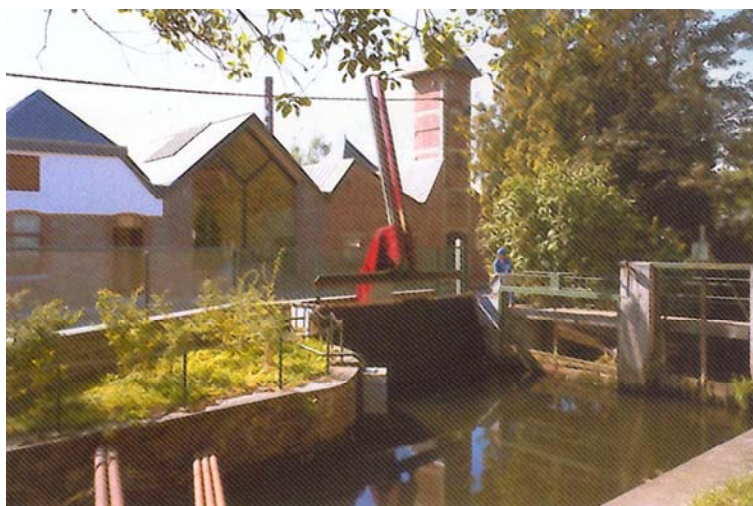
La zone possible d'aménagement d'un exutoire de dévalaison de surface dans la vanne de vidange au fond du canal d'amenée, dans le prolongement du plan de grille de la CHE de Stavelot-Bressaix sur l'Amblève (document Electrabel, 2002).
